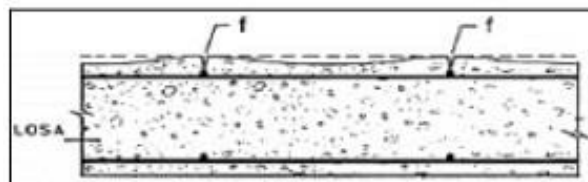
Grietas por asentamiento del concreto fresco
